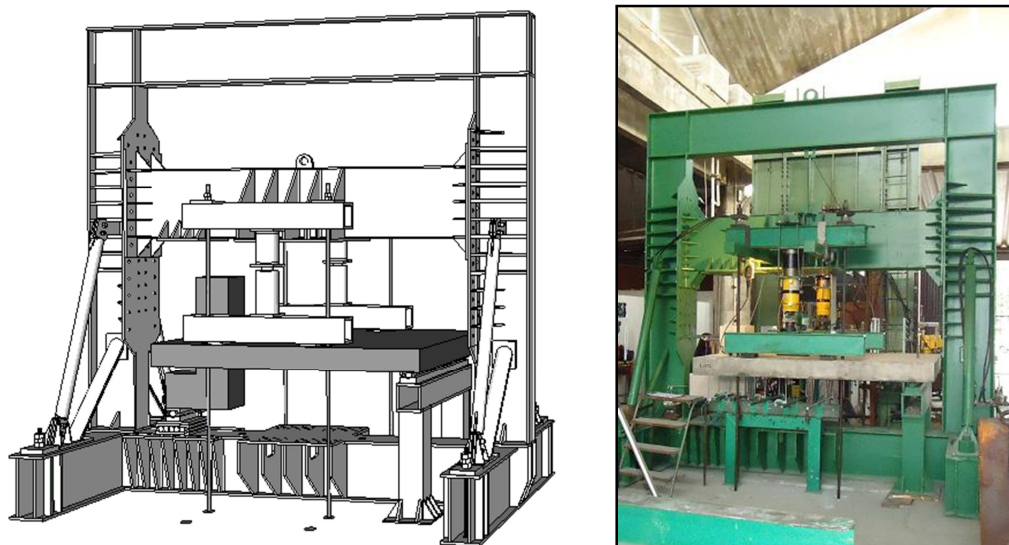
Pórtico utilizado no sistema de ensaio
